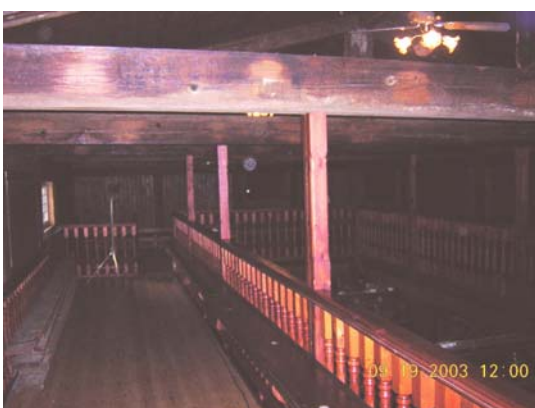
Till höger i bild ses öppningen ner till första och andra plan
